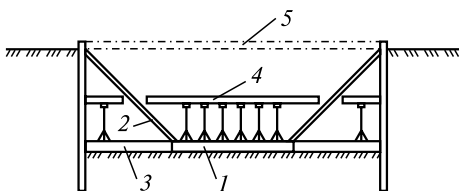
Схема котлована с распорным перекрытием нижнего этажа:
